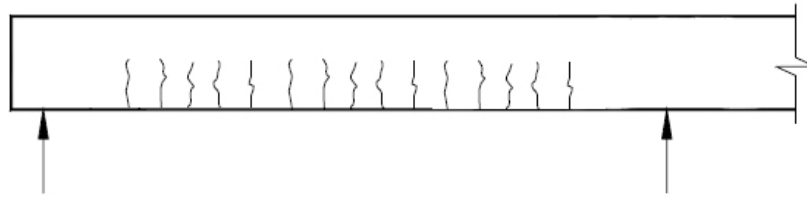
Fissuras de flexão (viga sub-armada). (IPR Publicação, 709 – 2004).
